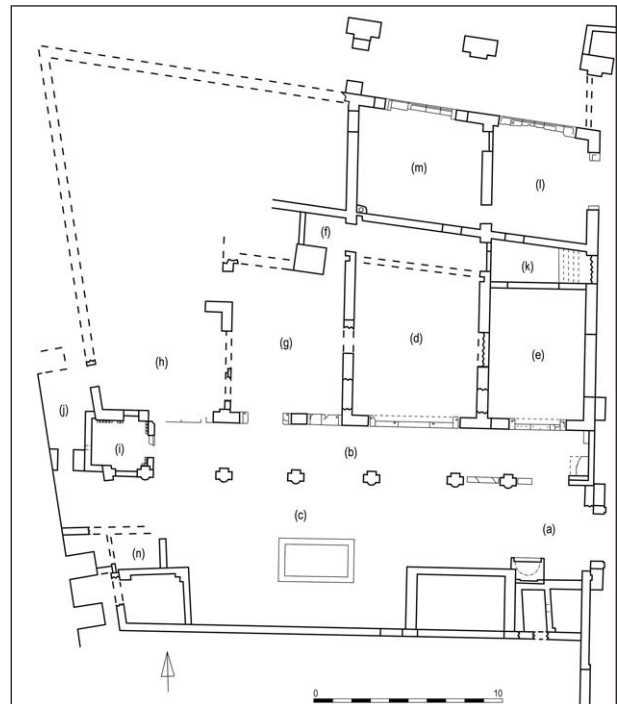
Caseggiato di Bacco e Arianna, Grundriss
